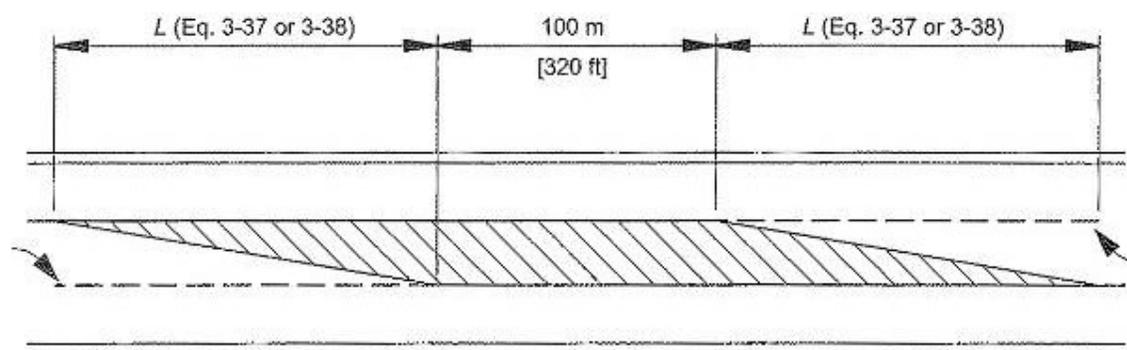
Esquema para Adyacentes Abocinamientos de pérdida de carril en calzada 2+1
